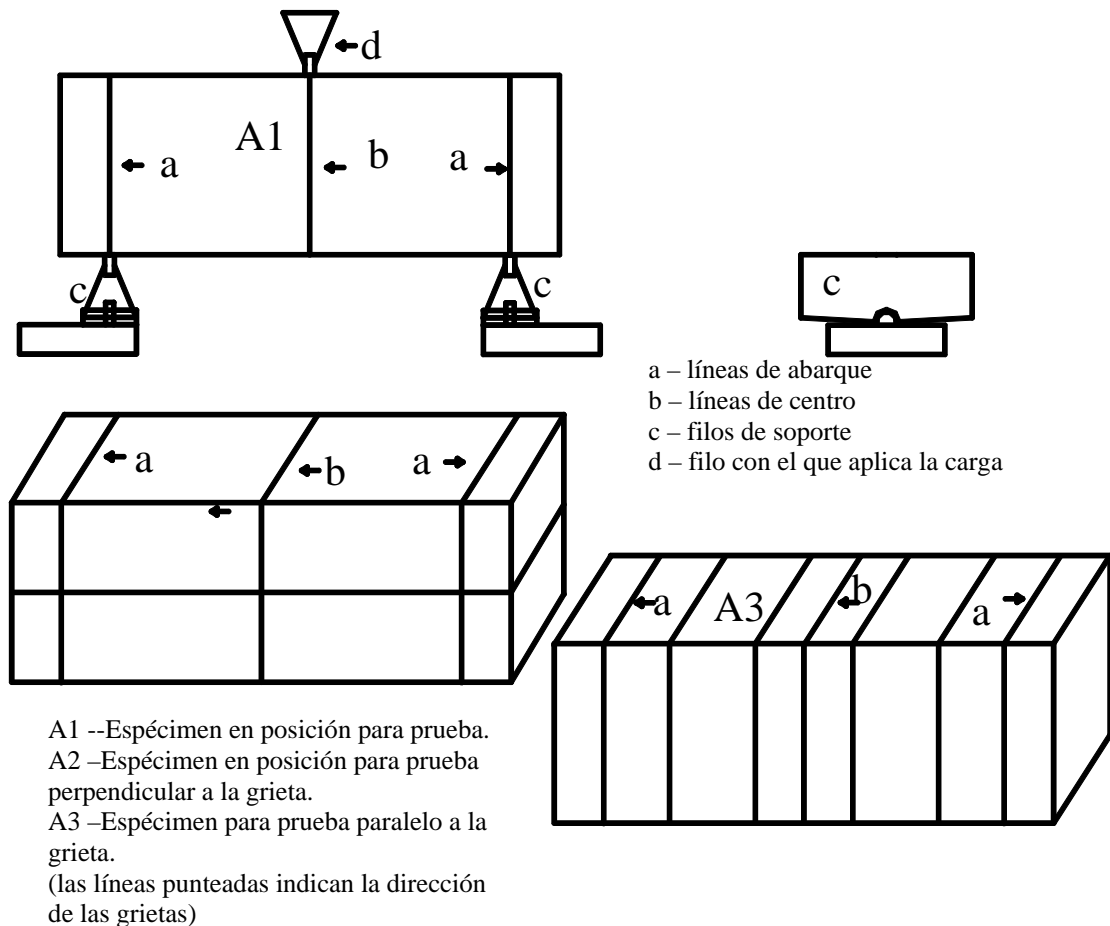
Especimen y tipo preferido de filos para determinar el módulo de ruptura en rocas para construcción.
